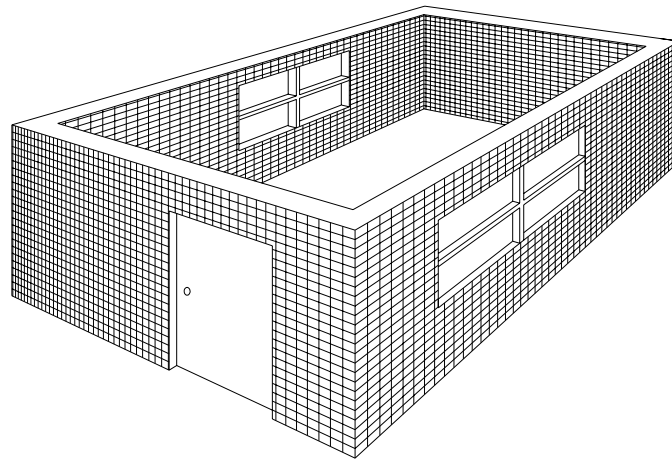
REFUERZO TOTAL CON MALLA ELECTRO SOLDADA
